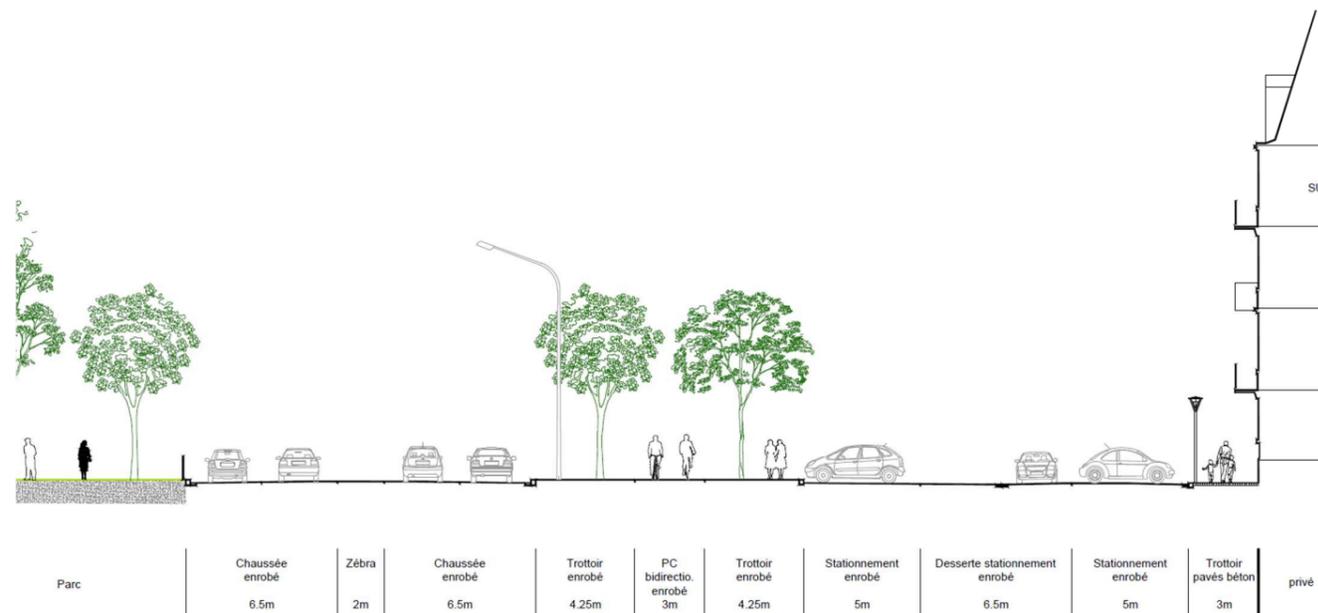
Plan de la place de Haguenau (source : AVP GETAS, 2023)
